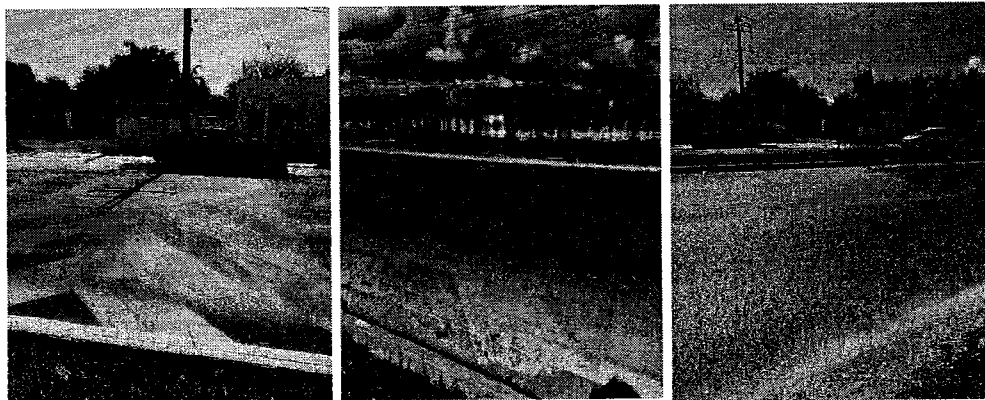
Condición del señalamiento horizontal en Av. Álvaro Obregón (marcas con desgaste avanzado). Fuente: Elaboración propia (levantamiento en campo, 2025).
